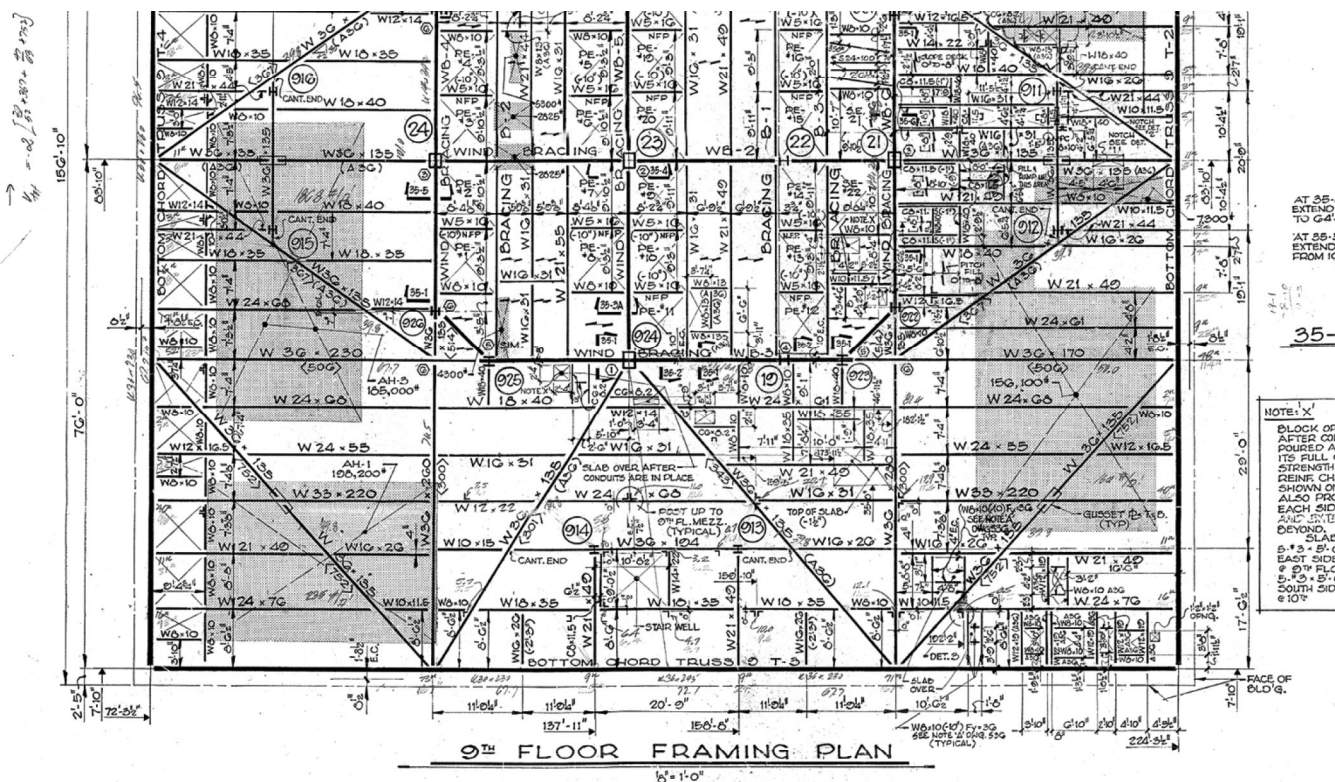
Fragmento del plano original de ejecución de la 9ª planta (planta base de la torre).
